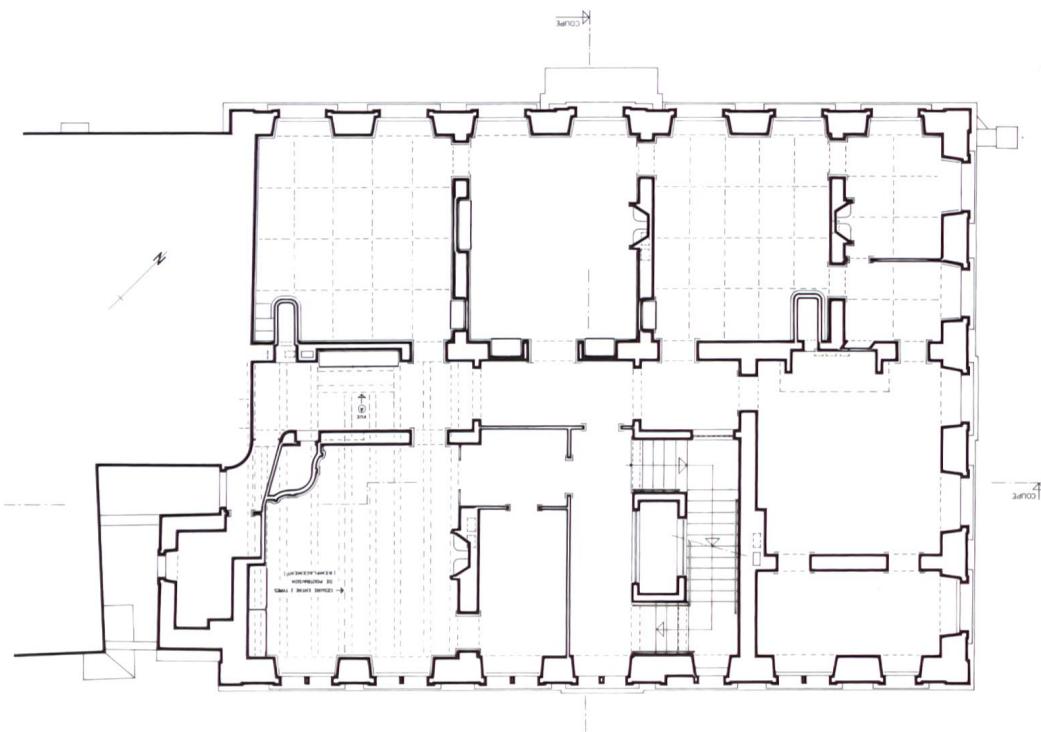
Moudon, maison Loys de Villardin. Plan du premier étage. Dessin René Tosti 1992.
